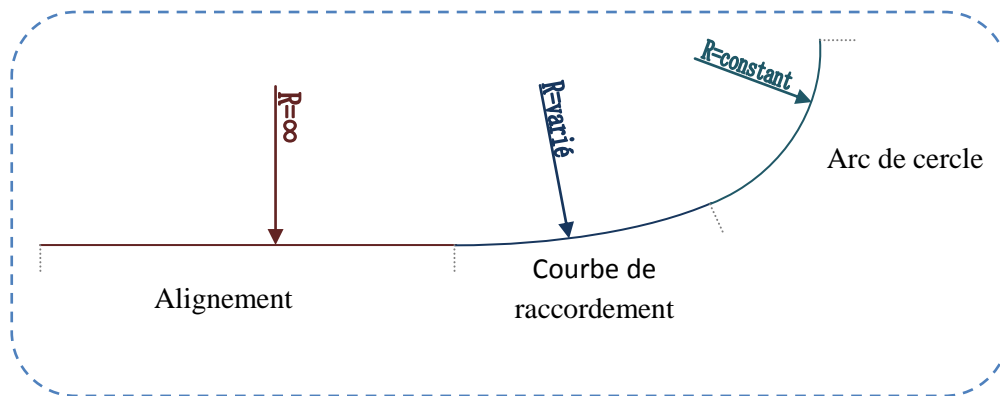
Les Eléments Du Trace En Plan [21]
